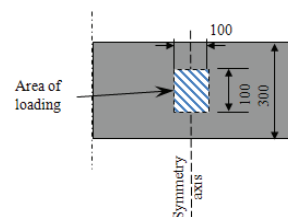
Géométrie, ferrailage et chargement des poutres AB13 et AB15
